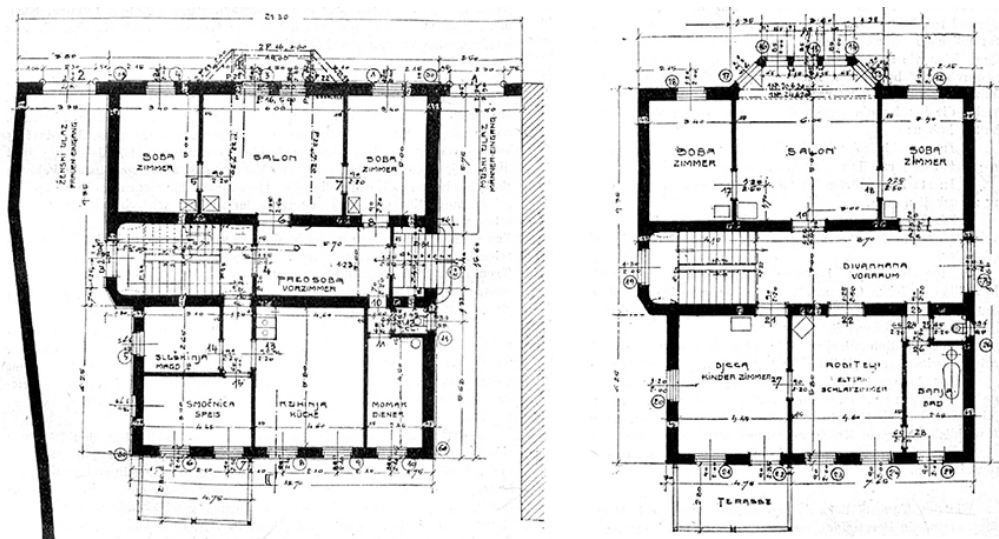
Banja Luka, former Husedžinović house, floor plans.
